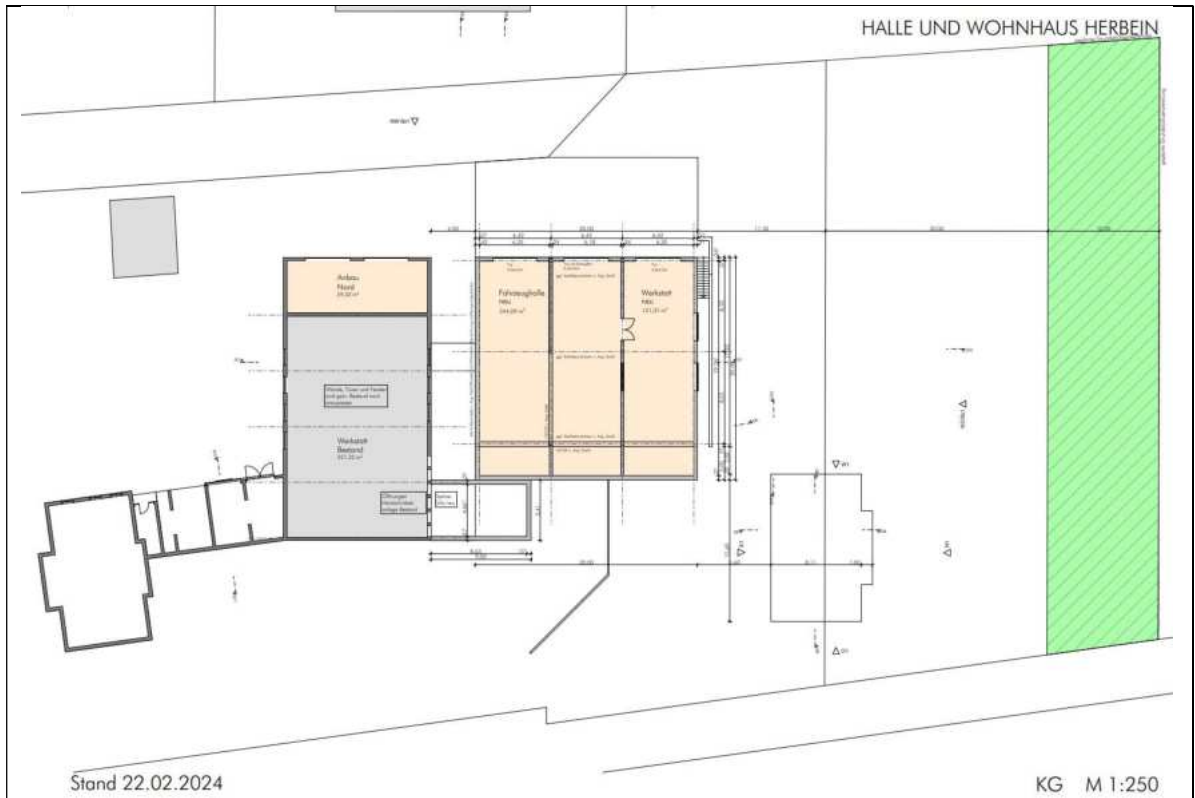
Grundriss, Schnitte und Ansichten für den Bestand und die geplanten (Bau-)Maßnahmen gemäß [a] (Verfasser: abtplan - architektur & stadtplanung“)
